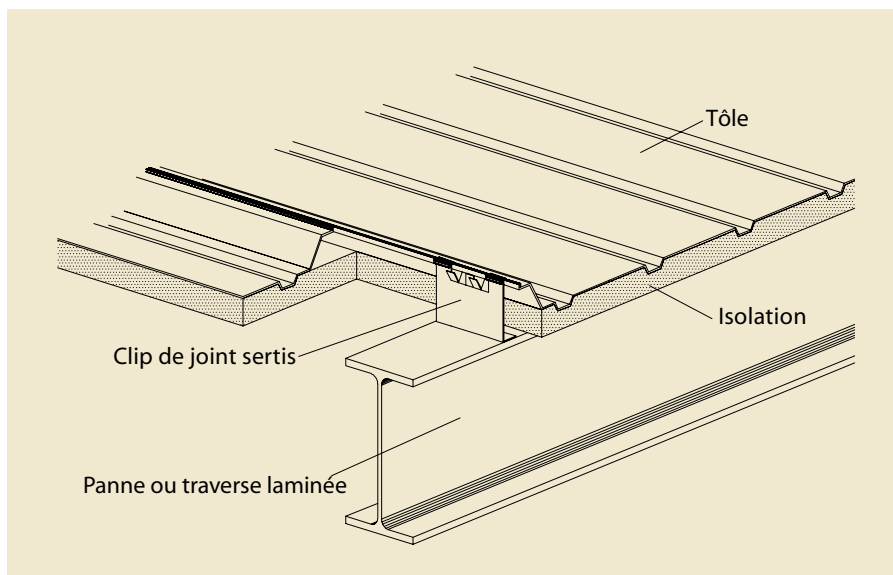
(Haut gauche) Panneaux à joints sertis avec plateaux de doublage
